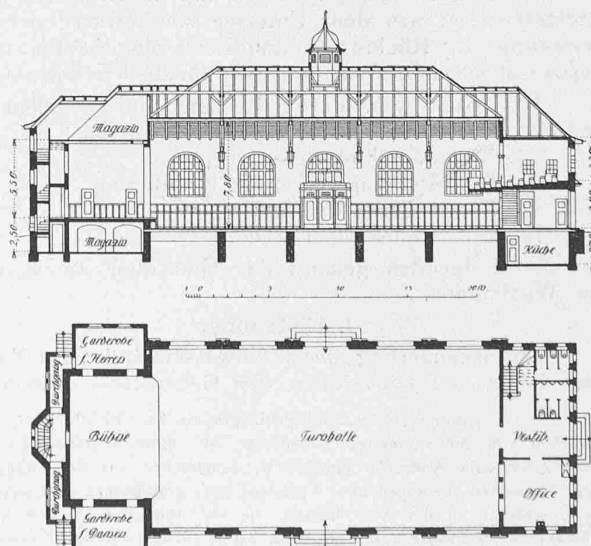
und 4. Grundriss und Schnitt. — Masstab 1 : 500.
